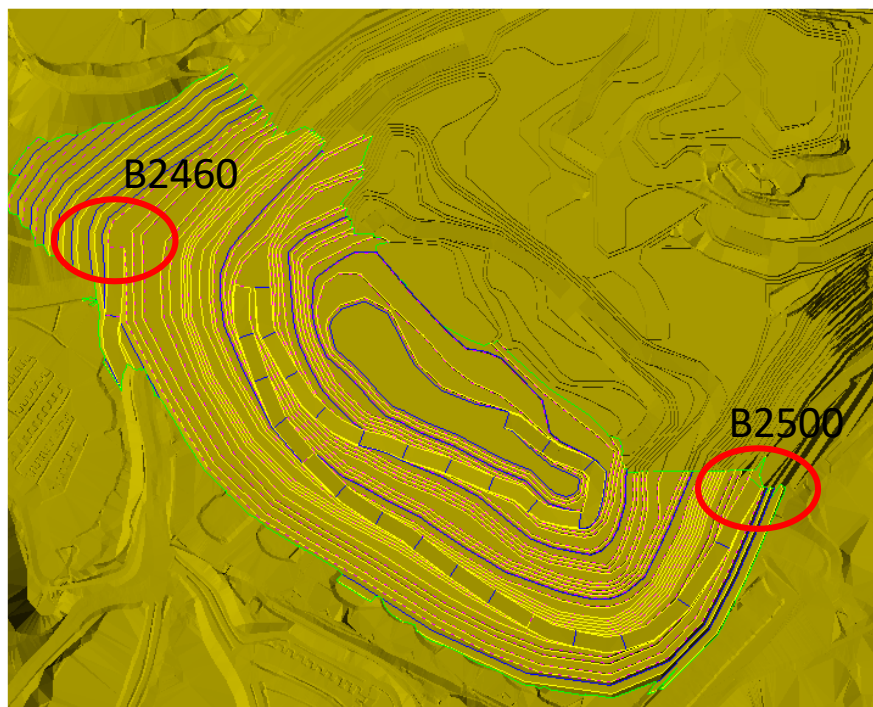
Vista en planta Fase 5 opción 2 con foto Fase 4 opción 2
